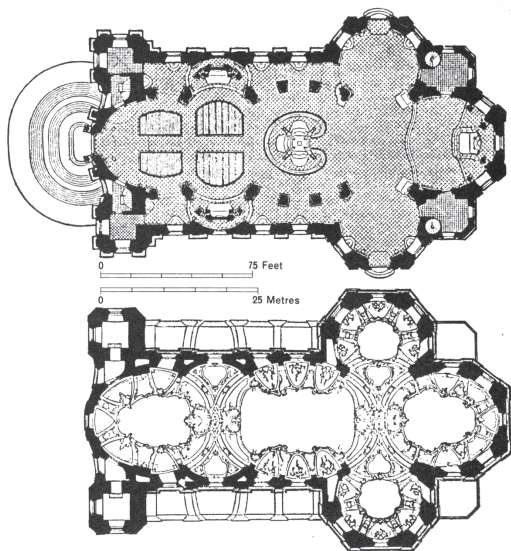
Planta baixa e planta da abóbada da Igreja de Vierzeñheiligen.
